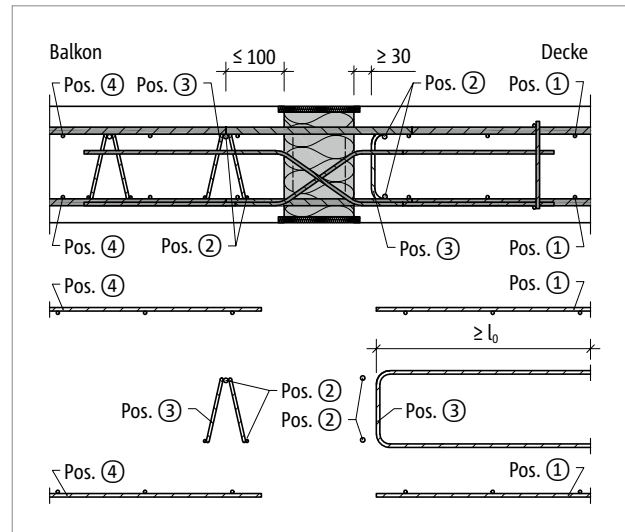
Schöck Isokorb® XT Typ DP: Bauseitige Bewehrung mit Gitterträger
